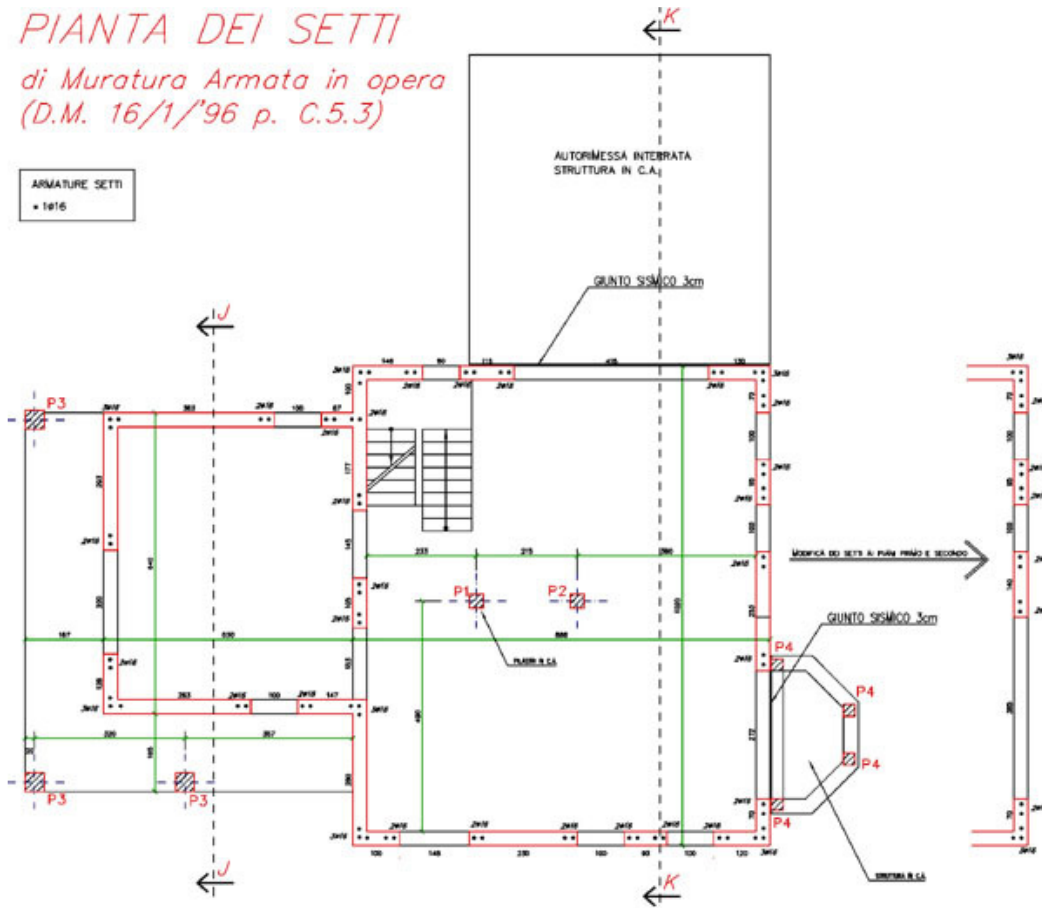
Schema della disposizione delle armature verticali nei setti murari.
